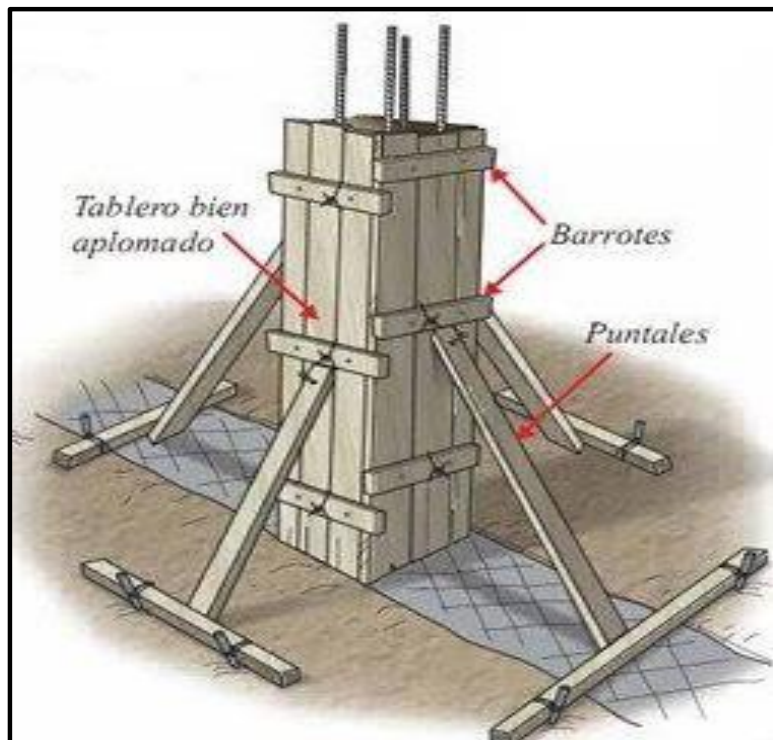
Encofrado de columna aislada. Nota: Fuente: Orihuela P. et al (2017).
